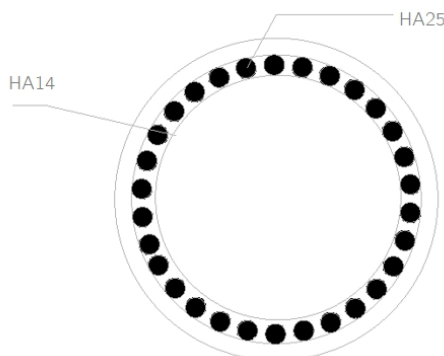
Schéma de ferrailage du pieu de la pile
